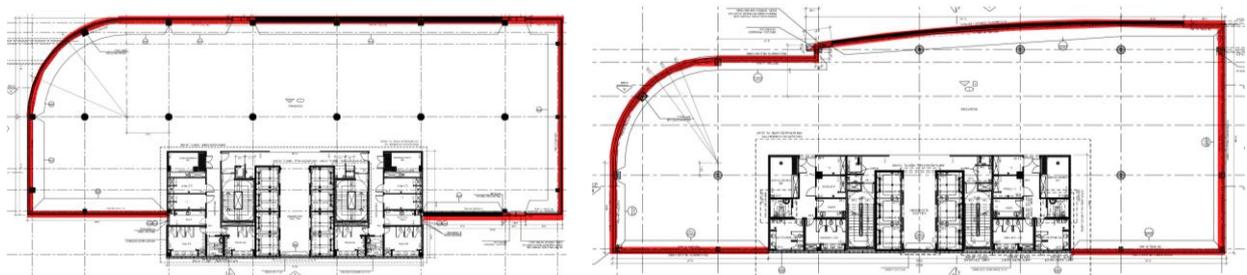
Plantas com perímetro em vermelho selecionamento a área envidraçada
